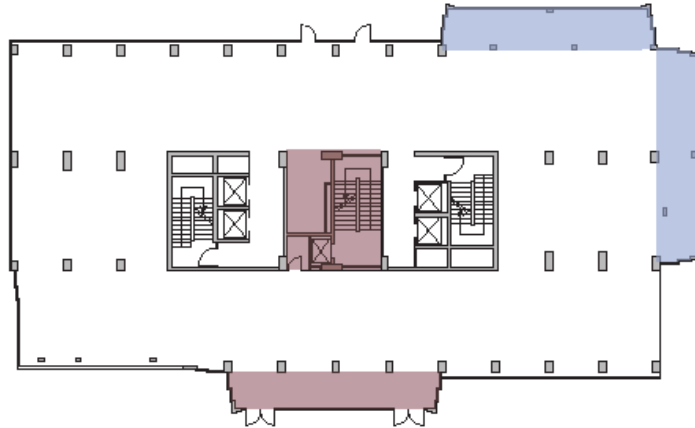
Progetto strutturale esecutivo. Pianta piano terra (Integrazione del 03/02/88)
